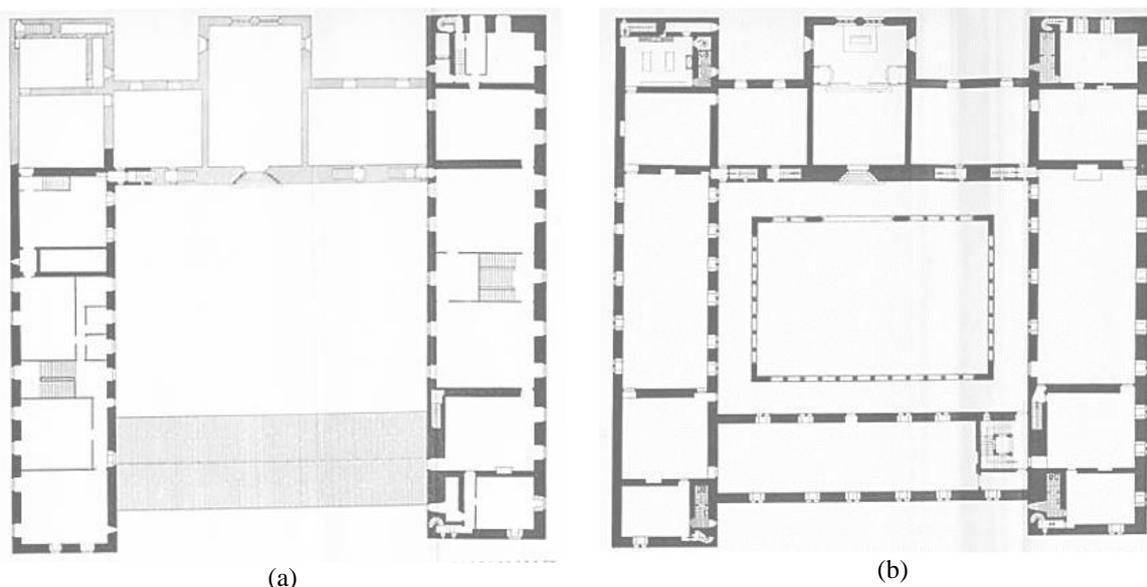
Planta primeiro pavimento: (a) Antes do restauro; (b) Depois do restauro.
